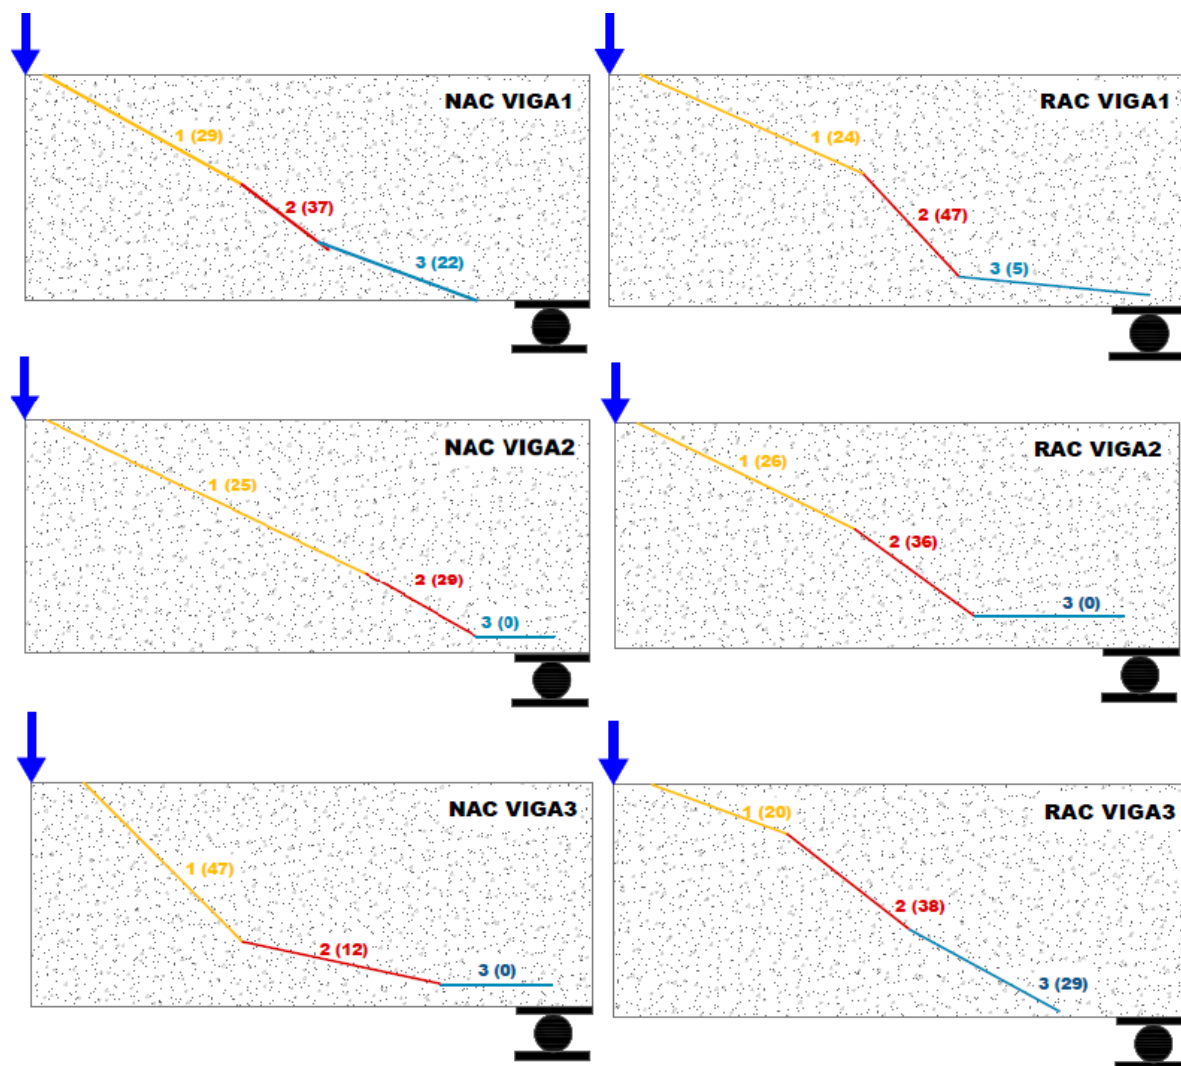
Formato simplificado da fissura diagonal crítica das vigas sem estribos.
